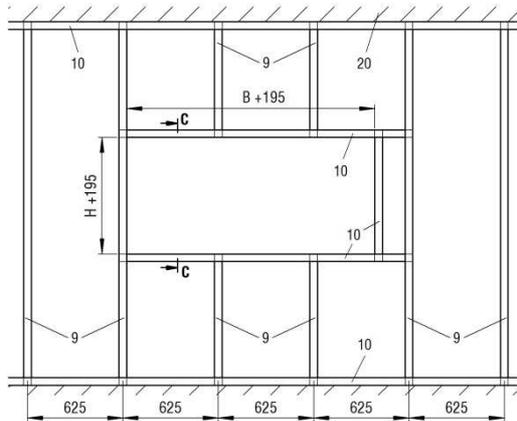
BKA-Ü mit Einbaurahmen ER eingebaut (Wanddicke = 100 mm)
